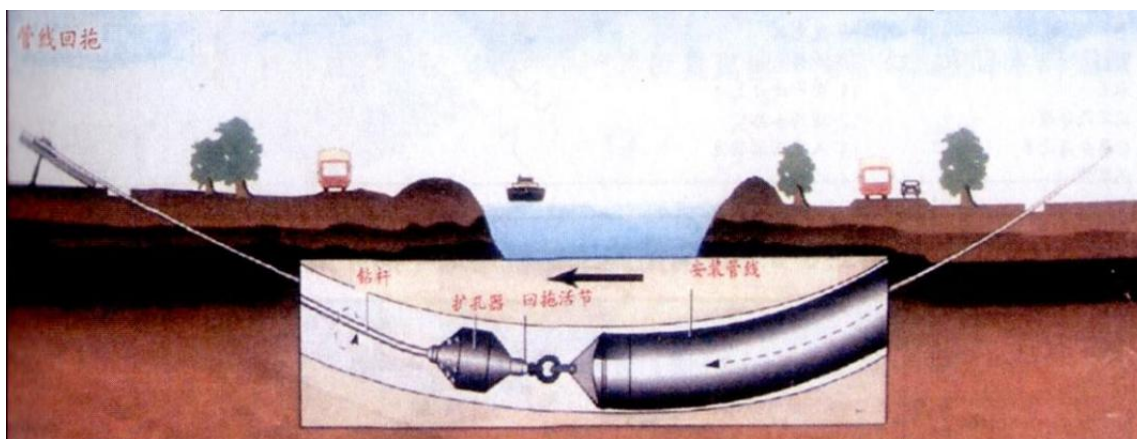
定向钻穿越施工管线回拖过程断面示意图
